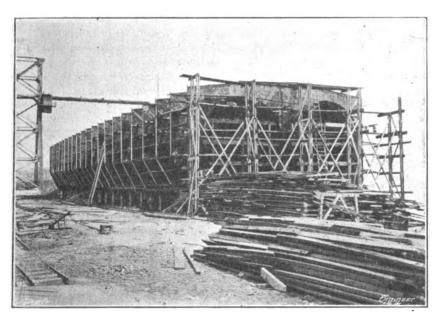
Tunnel sotto il Detroit River - Vista di una sezione in costruzione.
